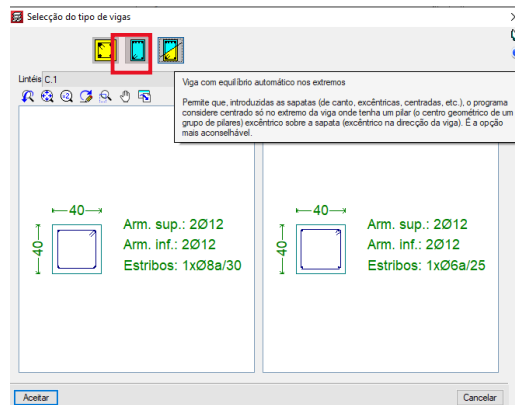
Viga de Equilíbrio Automático (Fonte: CYPE)
